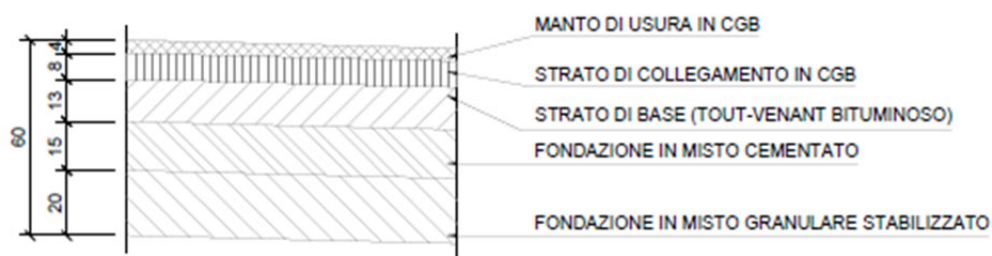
Pacchetto sovrastruttura stradale
